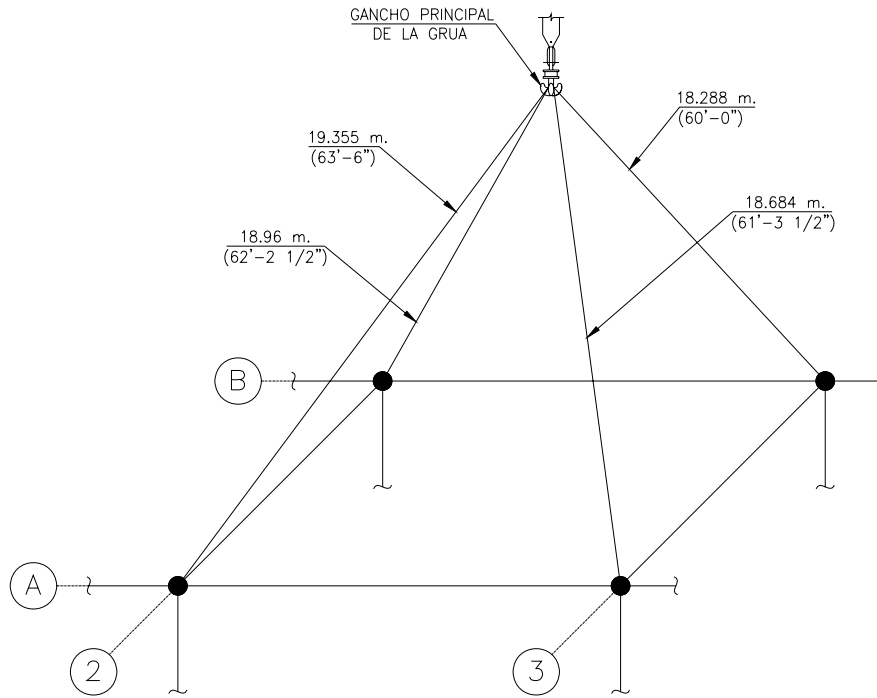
DETALLE DE ARREGLO PARA CABLES DE IZAJE
